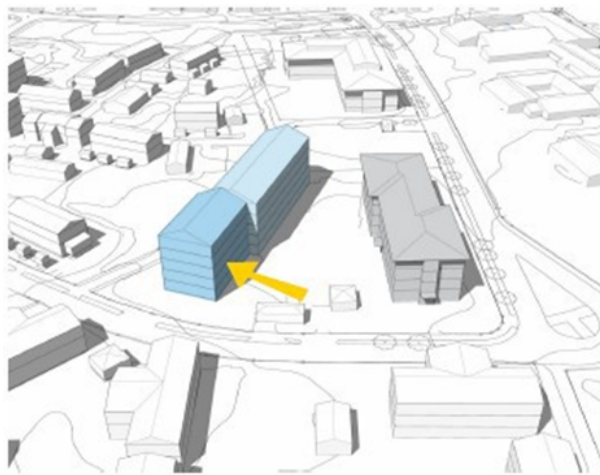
Gården öppnas mot söder för att bryta upp fasaden.
